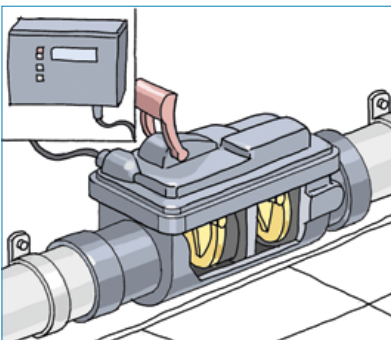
Elektronisch gesteuerter Rückstauverschluss – erforderlich bei fäkalienhaltigem Abwasser
